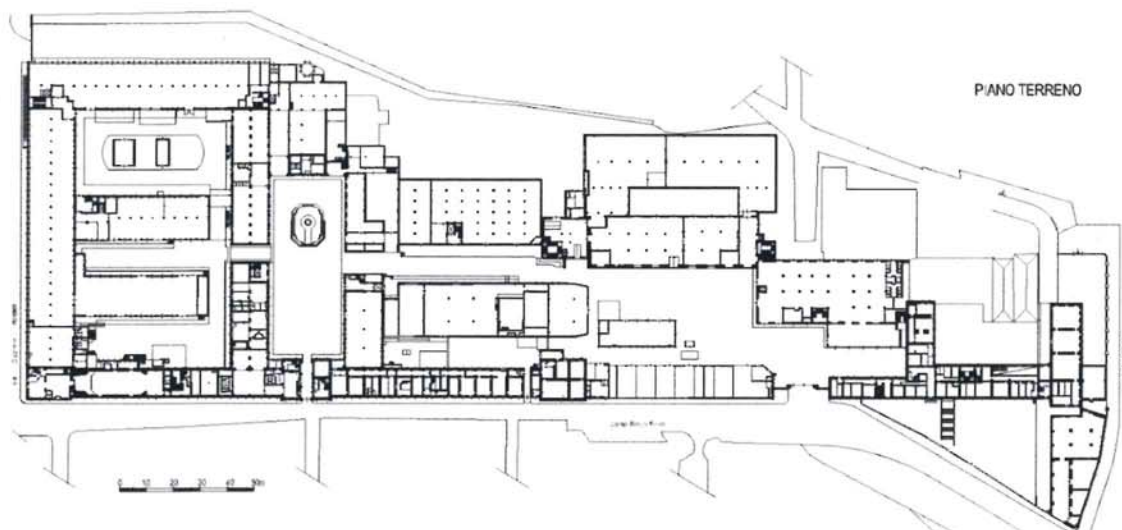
Ex Manifattura Tabacchi - Planimetria dello stato di fatto – piano terra
